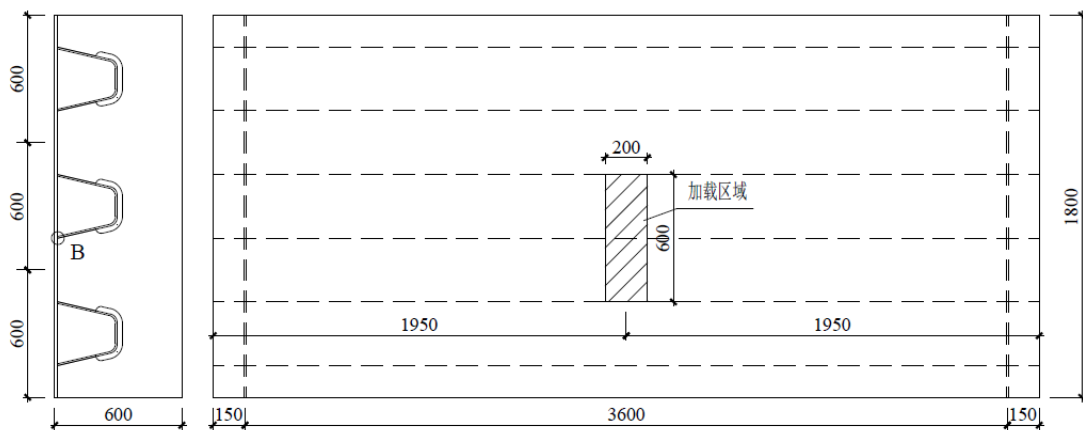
U 肋与顶板焊缝处节段模型几何尺寸
